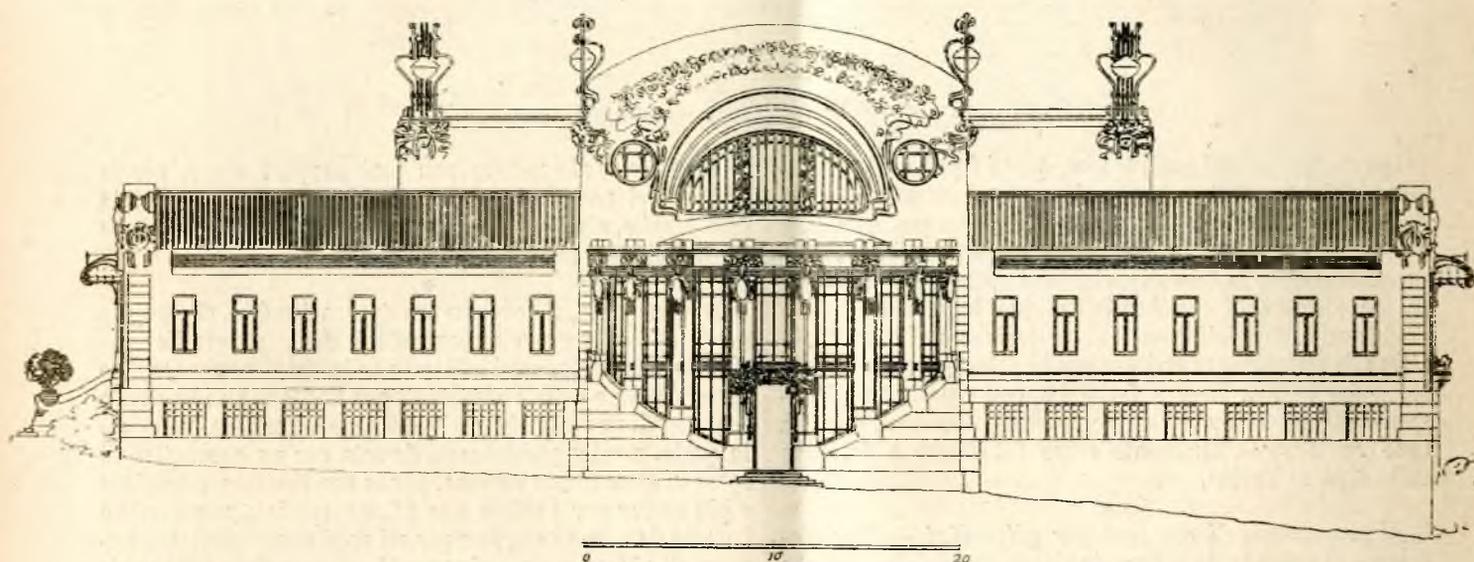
Palazzo dell'Esposizione. — Facciata rivolta a sud.
